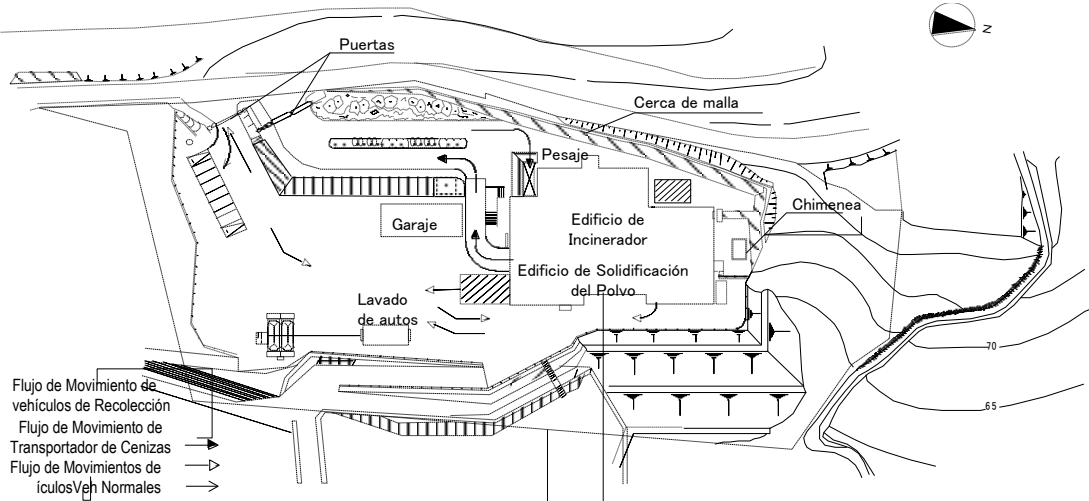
Plano de Distribución de la Planta de Incineración (Referencia: Sagara-cho, Japón)
